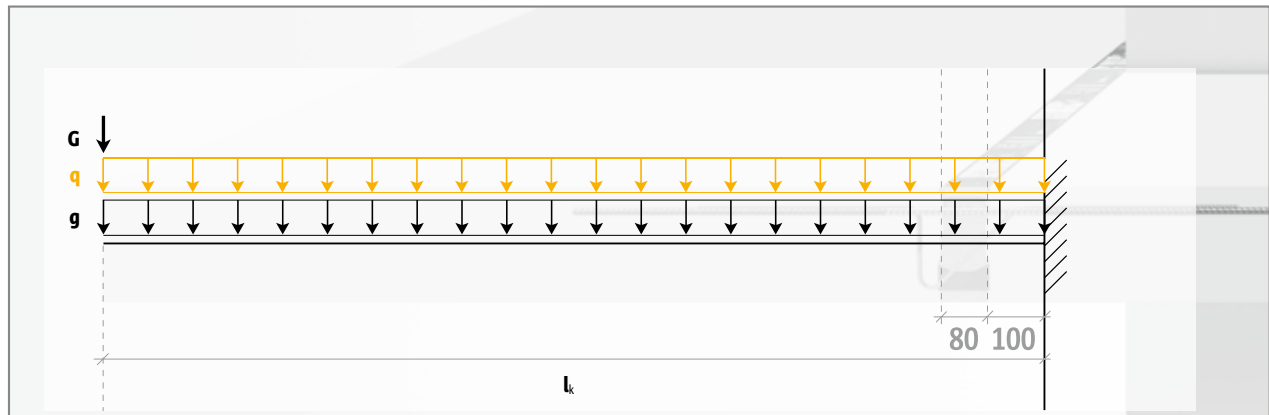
Schöck Isokorb® T tipo KL: ipotesi di carico
